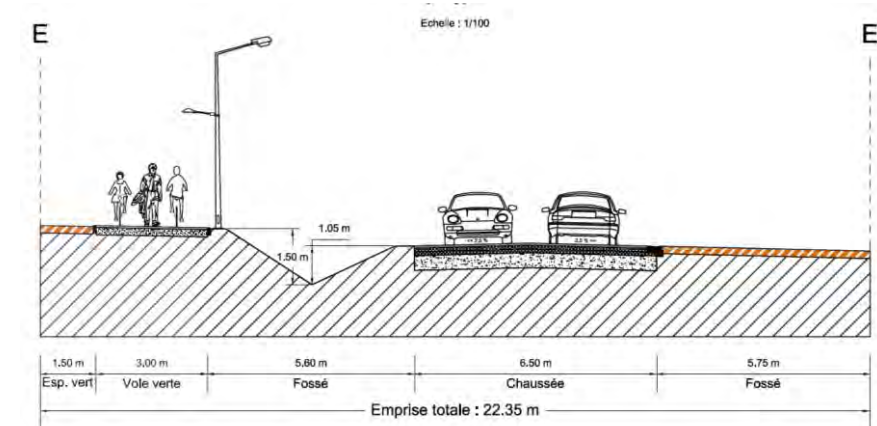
PROFIL EN TRAVERS ROUTE DU CUJAC - PARTIE SUD (SOURCE : J2C)
